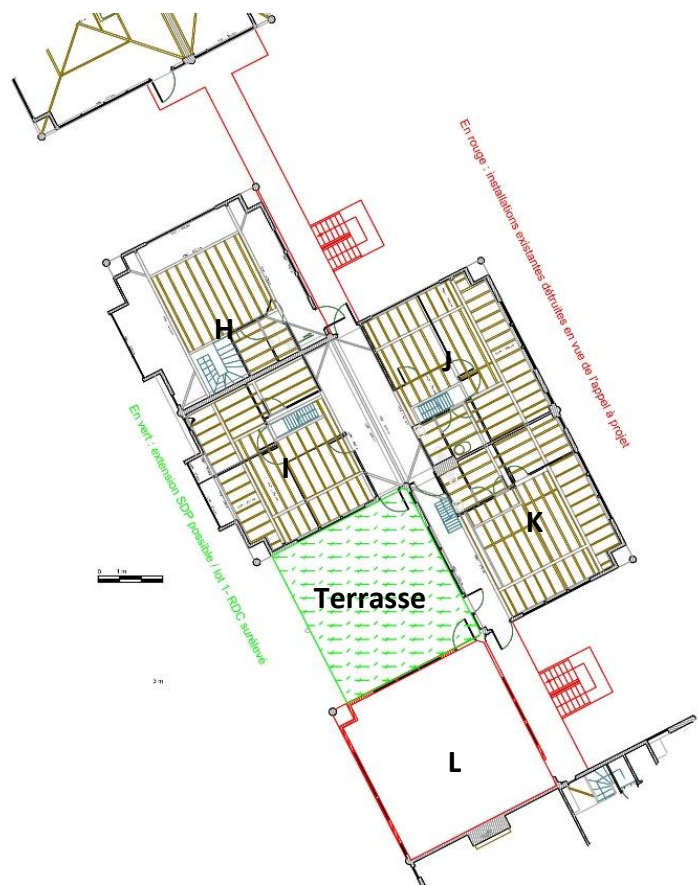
BATIMENT SUD - niveau rez-de-chaussée surélevé : démolitions réalisées par HAROPA (en rouge) et possibilité d'extension (en vert)
